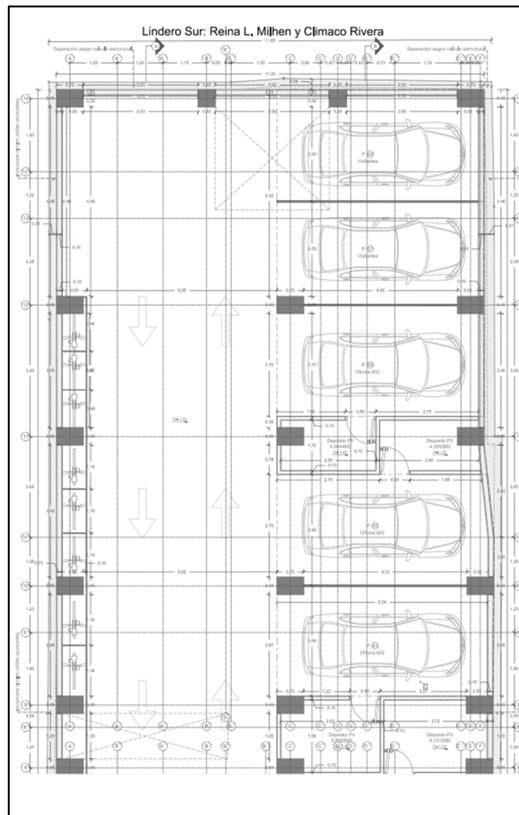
, Planta arquitectónica sótano bloque 2, Fuente: Constructora Open House
